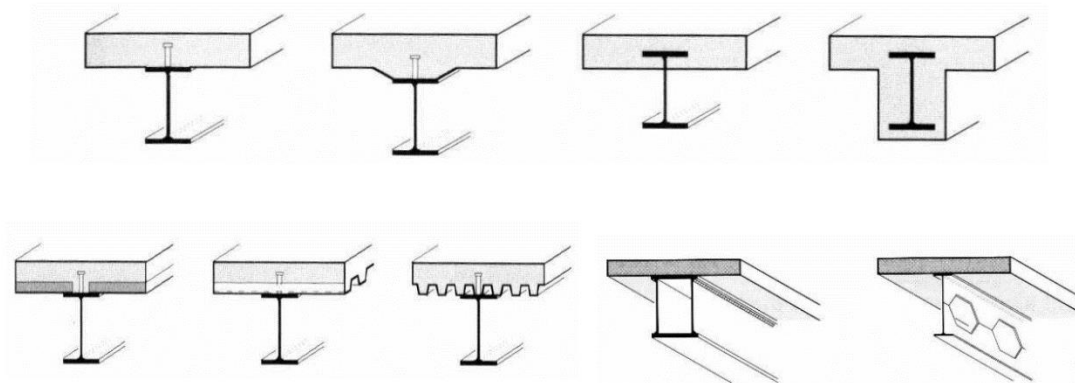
Exemplos de secções transversais de vigas mistas [3].
